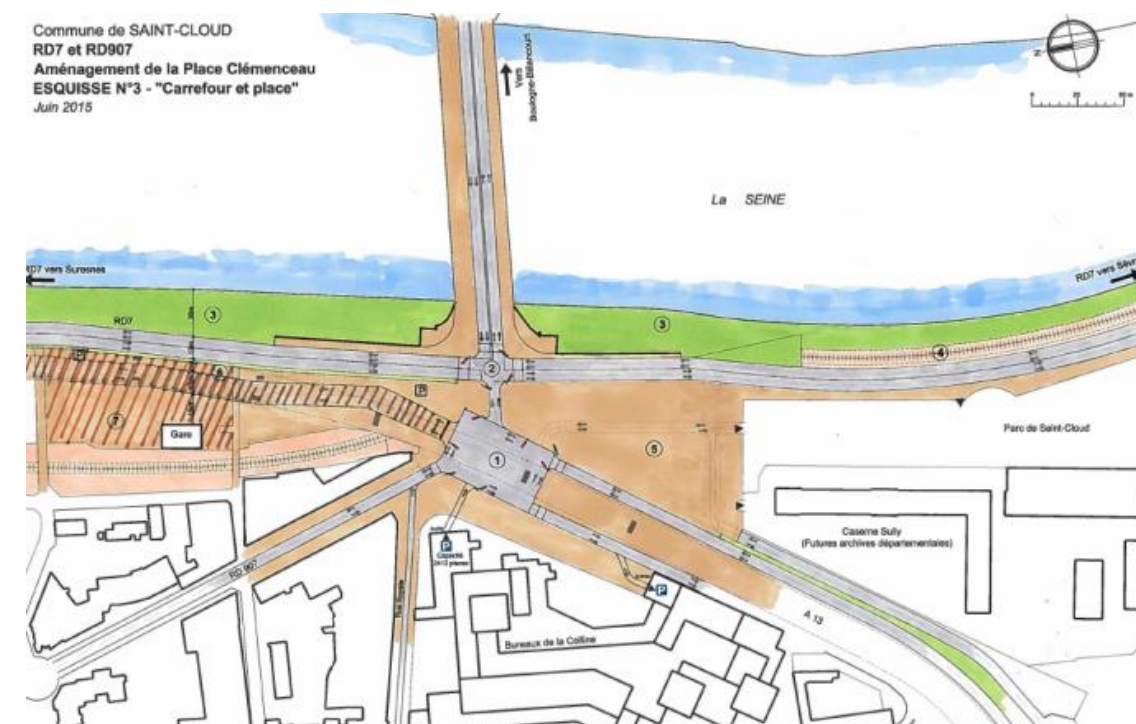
esquisse en configuration carrefour à 4 branches au niveau du pont et place en entrée de ville
